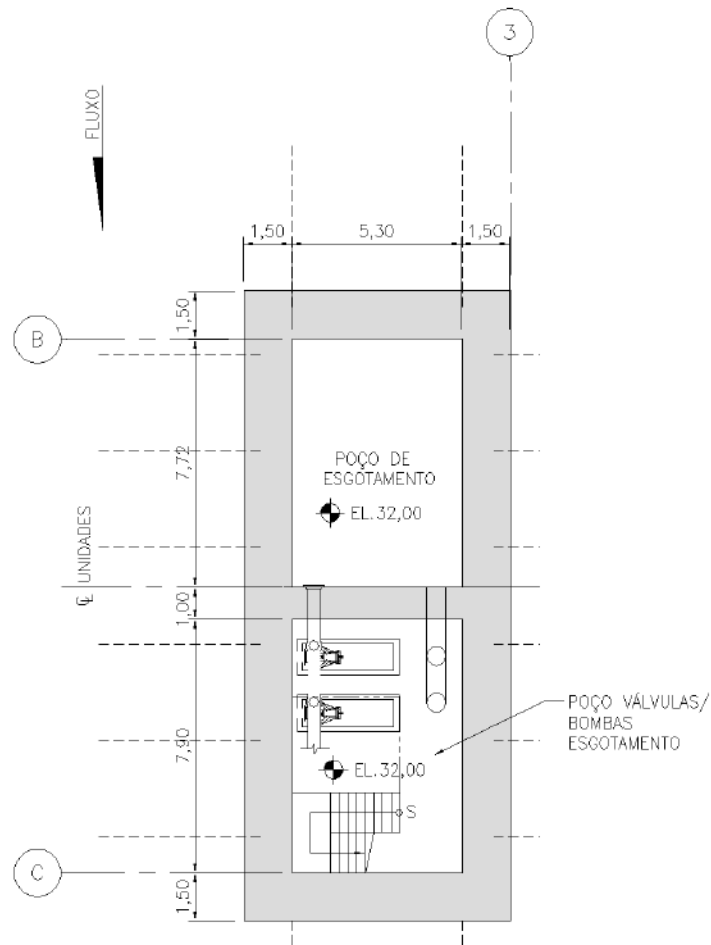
Planta EL.32,00 (Bloco lateral)
